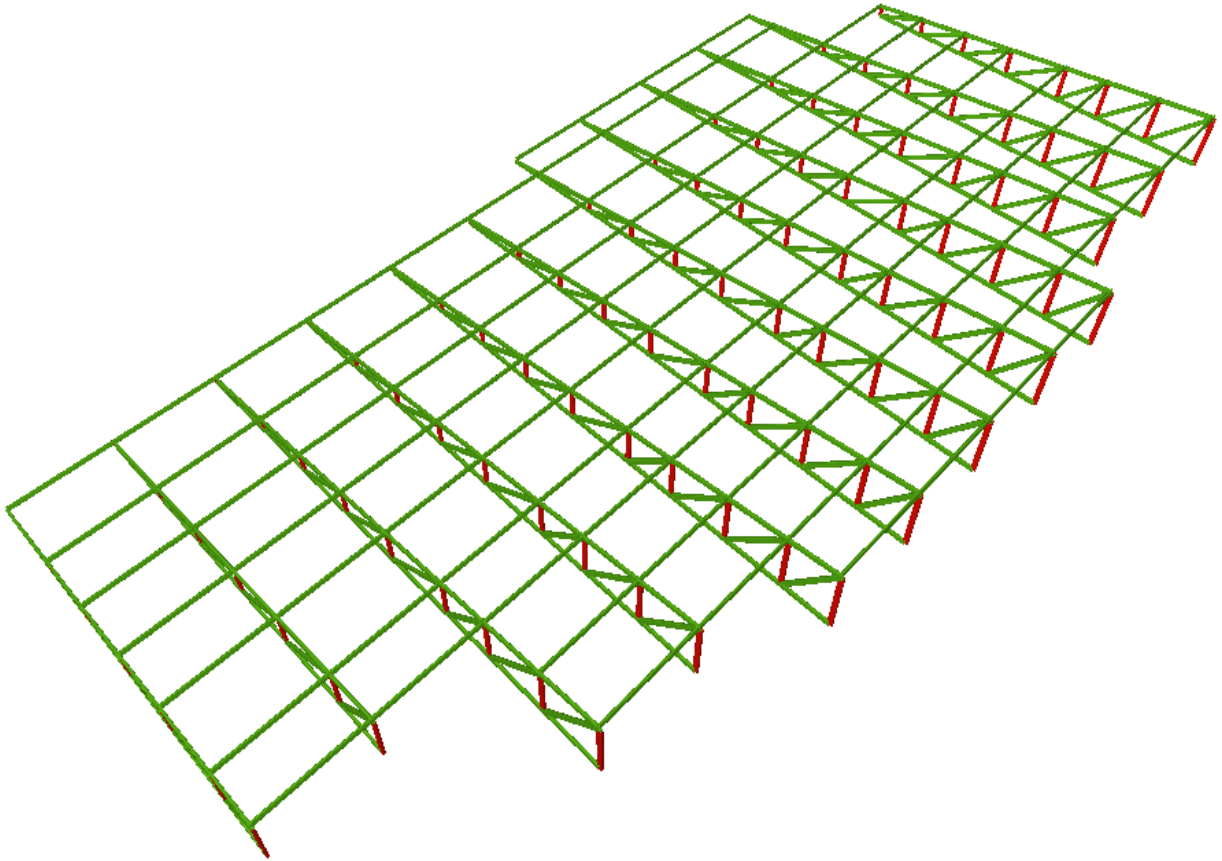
Cubierta de toda la estructura, Elaboración propia
